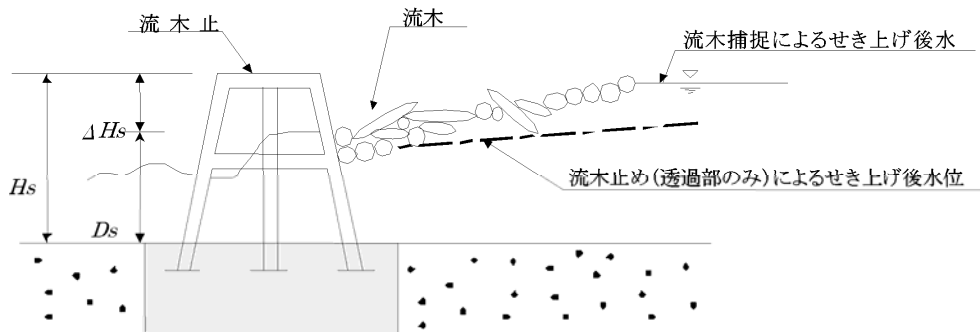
掃流区間に設置する流木捕捉工の透過部の高さ (H_s) の模式図
